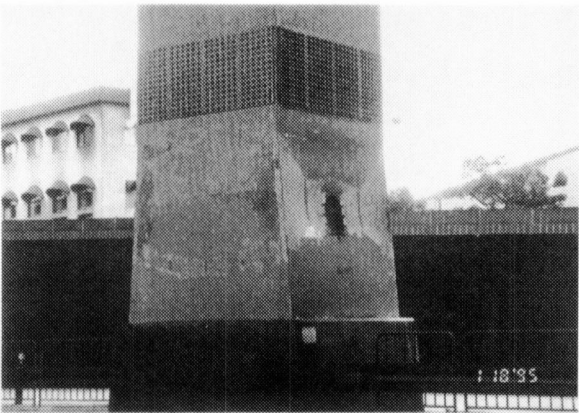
1. 2-7 鋼製橋脚の座屈（矩形断面）
